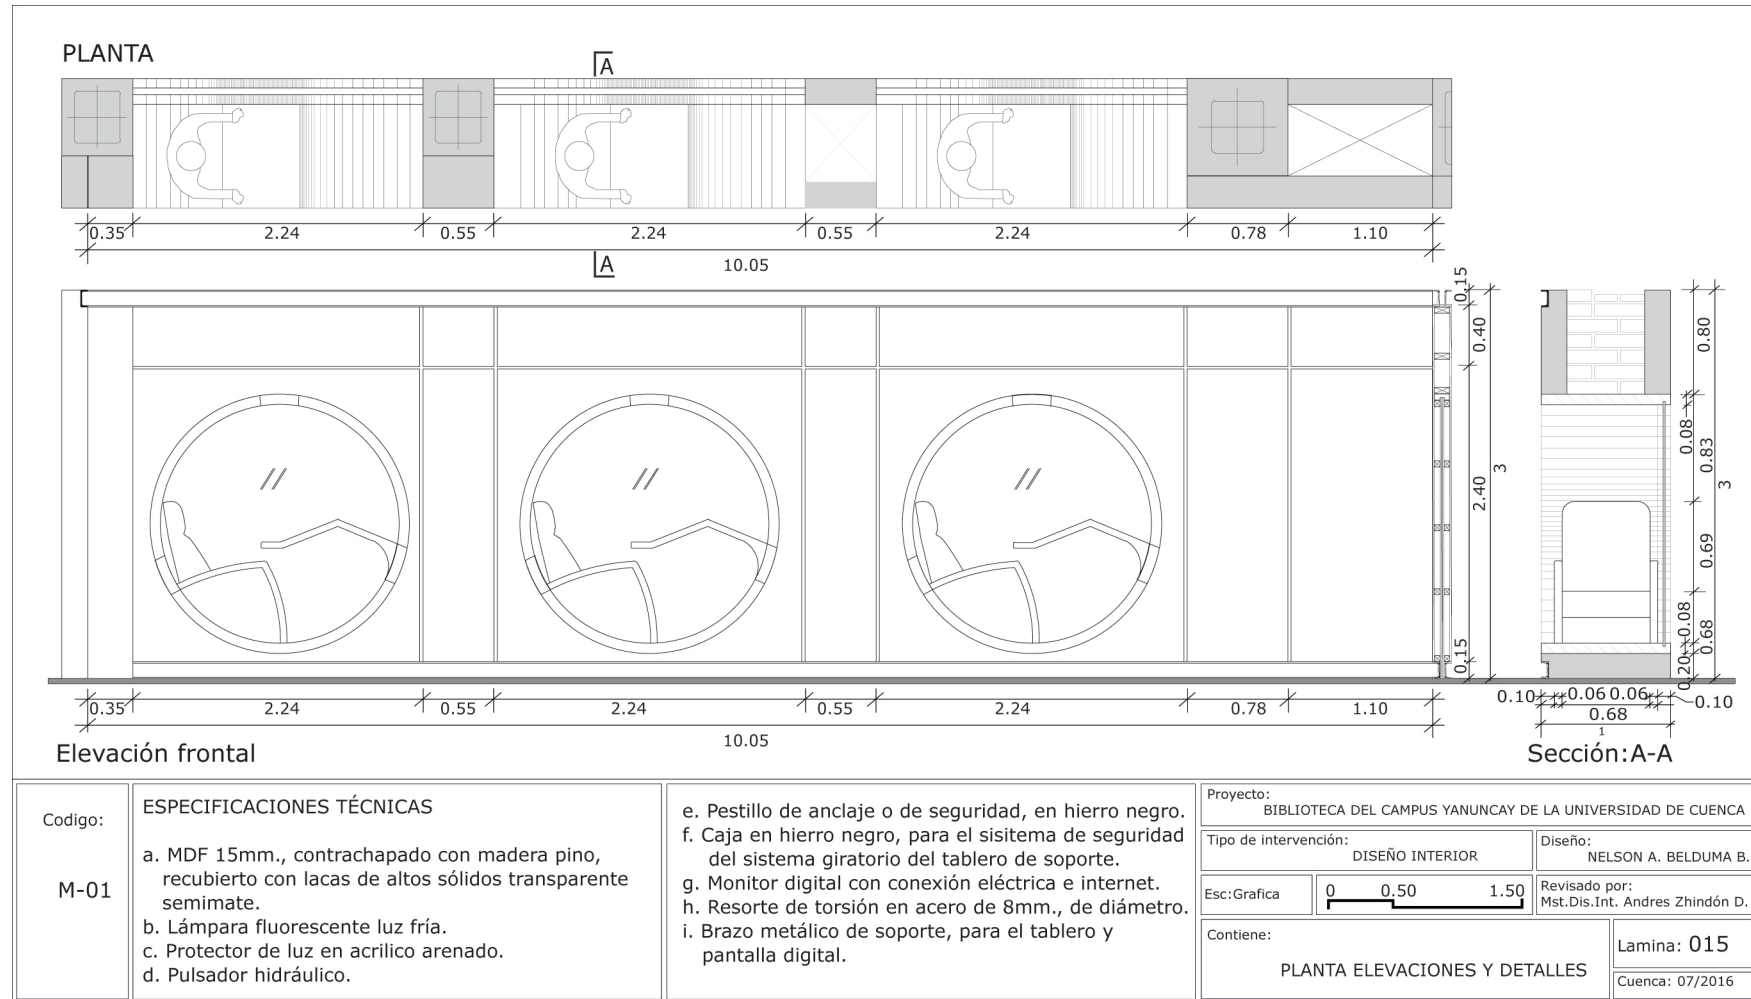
Planta, elevaciones y detalles. Sala de lectura. M-01.
